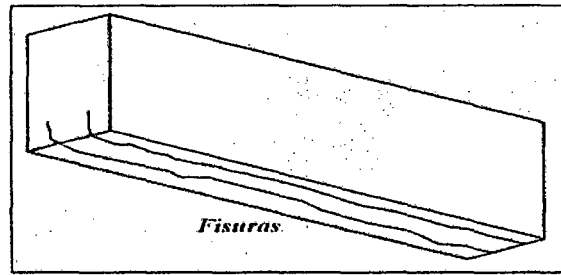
24. Fisuración longitudinal marcando la posición de la armadura principal Fuente: (Stuardo P., 2008)
